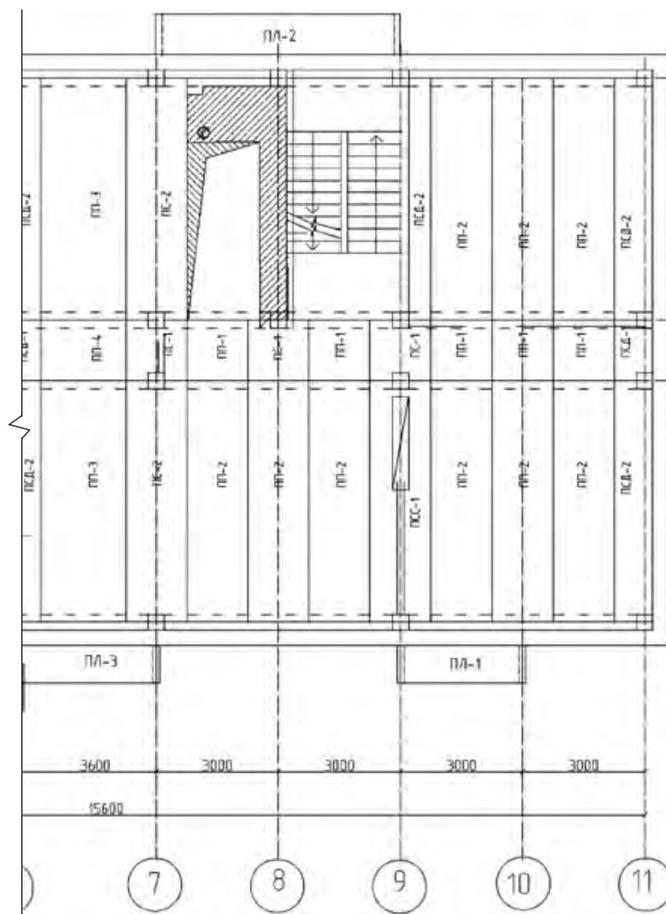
Фрагмент схемы расположения перекрытия в здании с продольным каркасом
